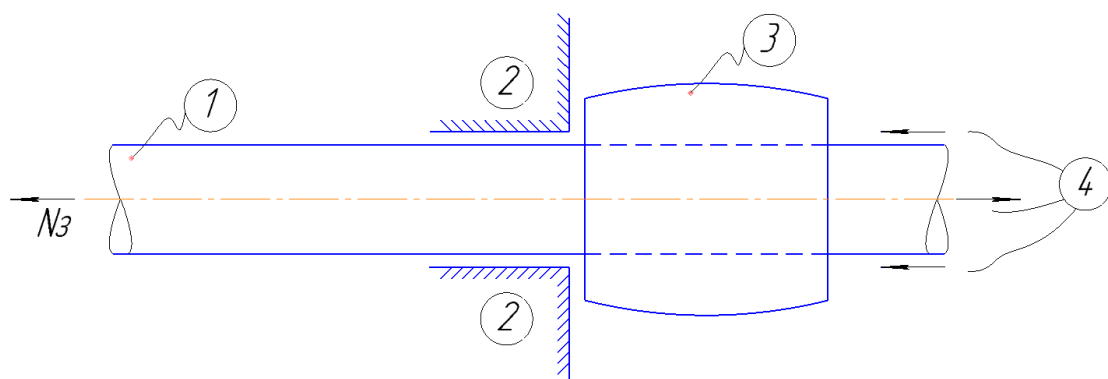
Анкер – опрессованная гильза: 1 – затяжка; 2 – конструкция; 3 – опрессованная гильза; 4 – устройство для передачи усилий
